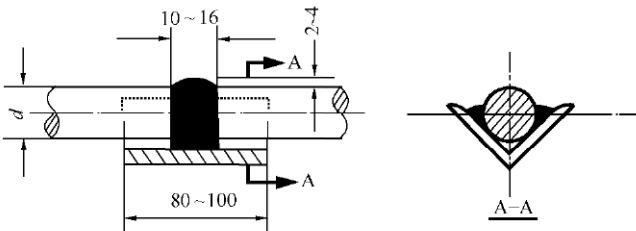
钢筋熔槽帮条焊接头
